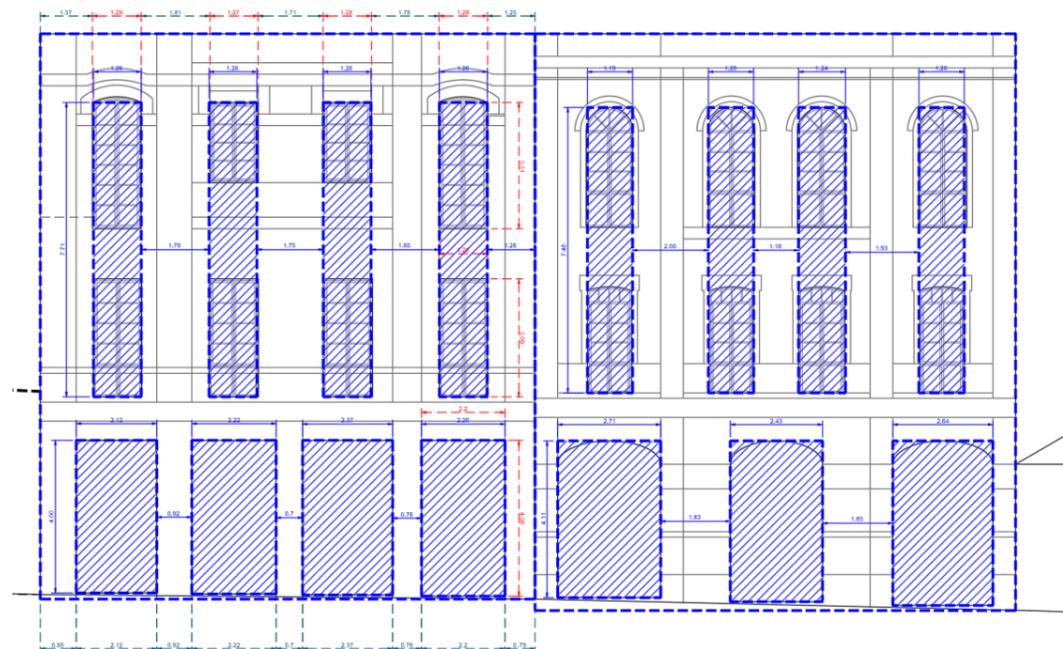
Acotado del alzado de la edificación adyacente
